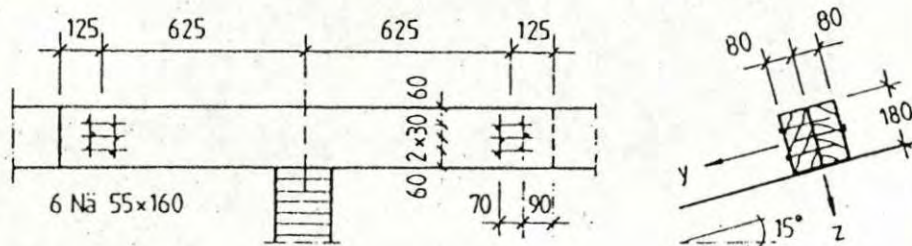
Koppelstoß von Hallendachpfetten aus Nadelvollholz mit nicht vorgebohrten, runden Draht- oder Maschinenstiften [44]
